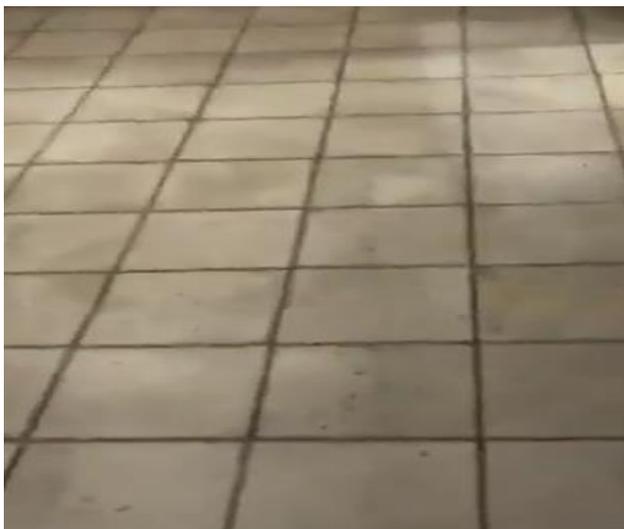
Aplicação do W-POXI PRP 301 sobre piso cerâmico existente
